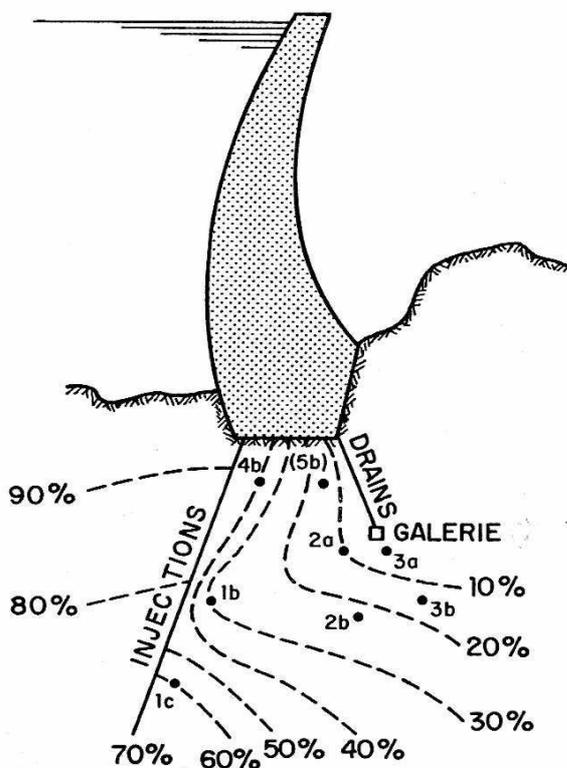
Réseau d'écoulement dans la fondation d'un barrage en béton
